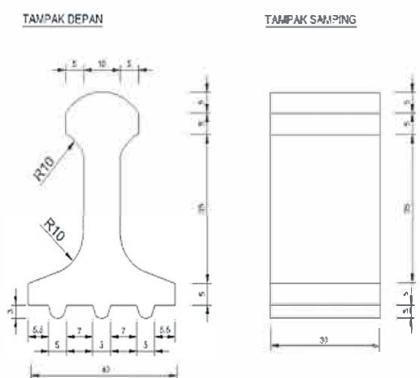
Modul Dinding atau Lantai Tipe-T Beton Pracetak Modular
